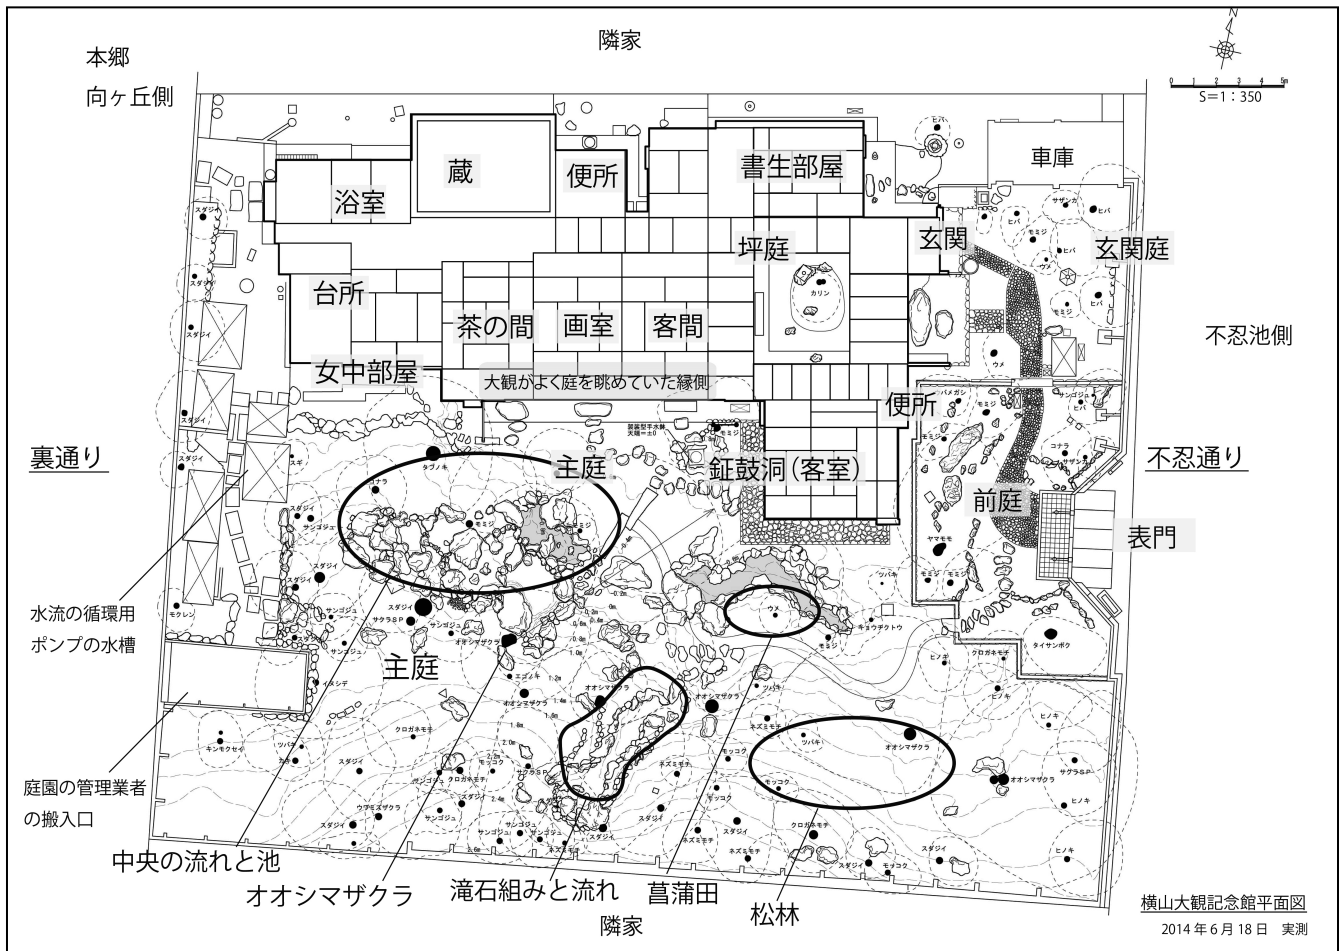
旧横山大観邸母屋および庭園の現況平面図¹⁵⁾
